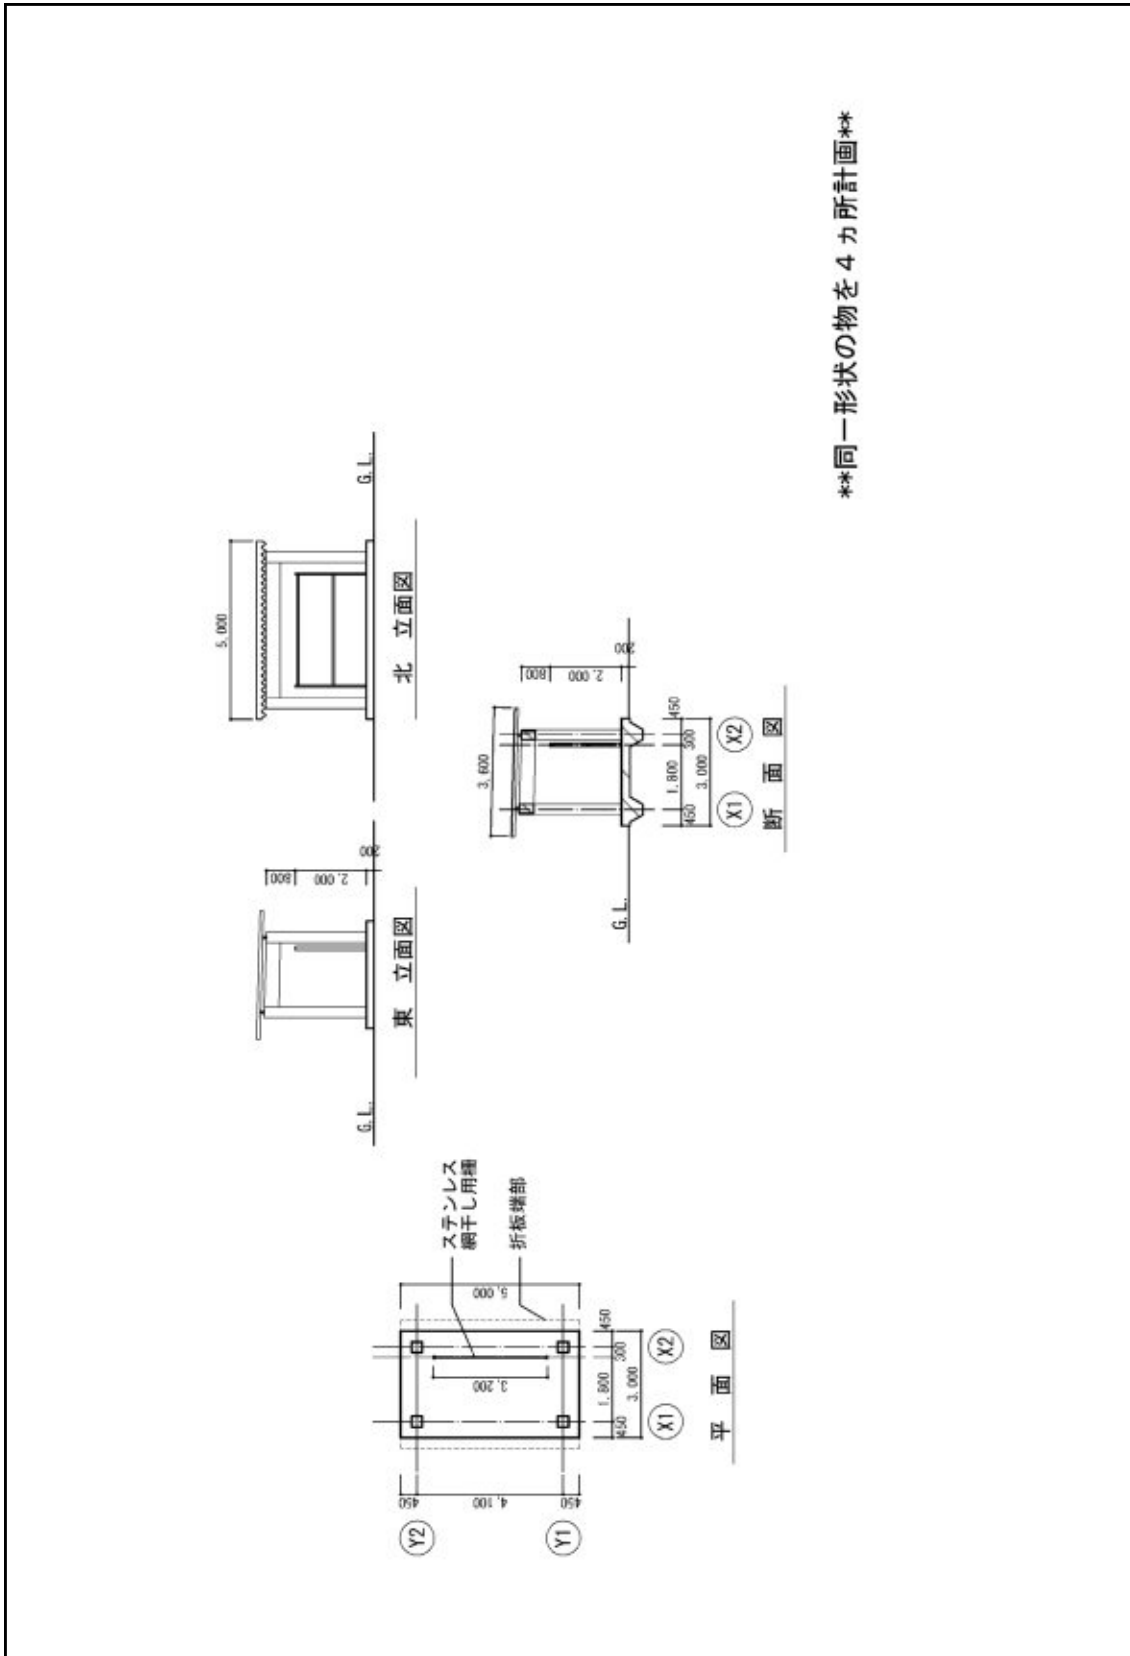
(20) ワークショップ 平面図、断面図、立面図
